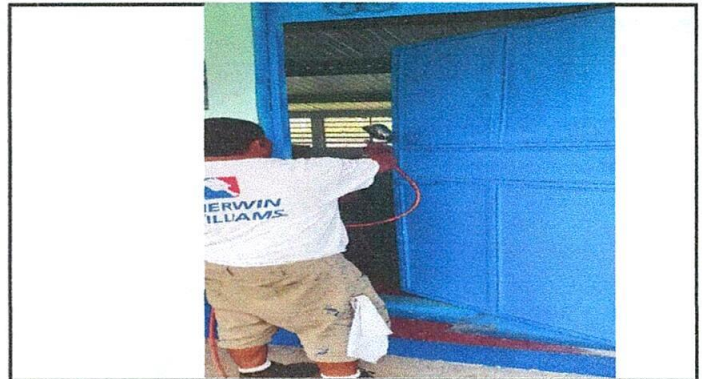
Mantenimiento a puertas (lijado y aplicación de pintura)
